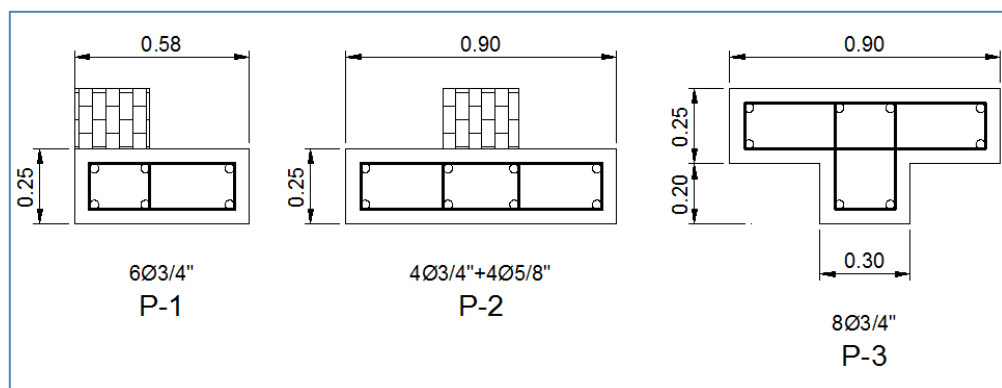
Detalle del refuerzo de las columnas (Edificio 780 actual)
